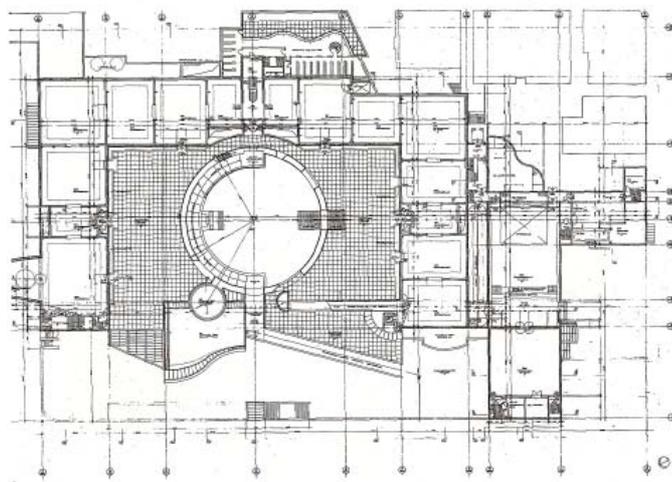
Planta baixa: Museu Staasgalerie, 1977-1983.
